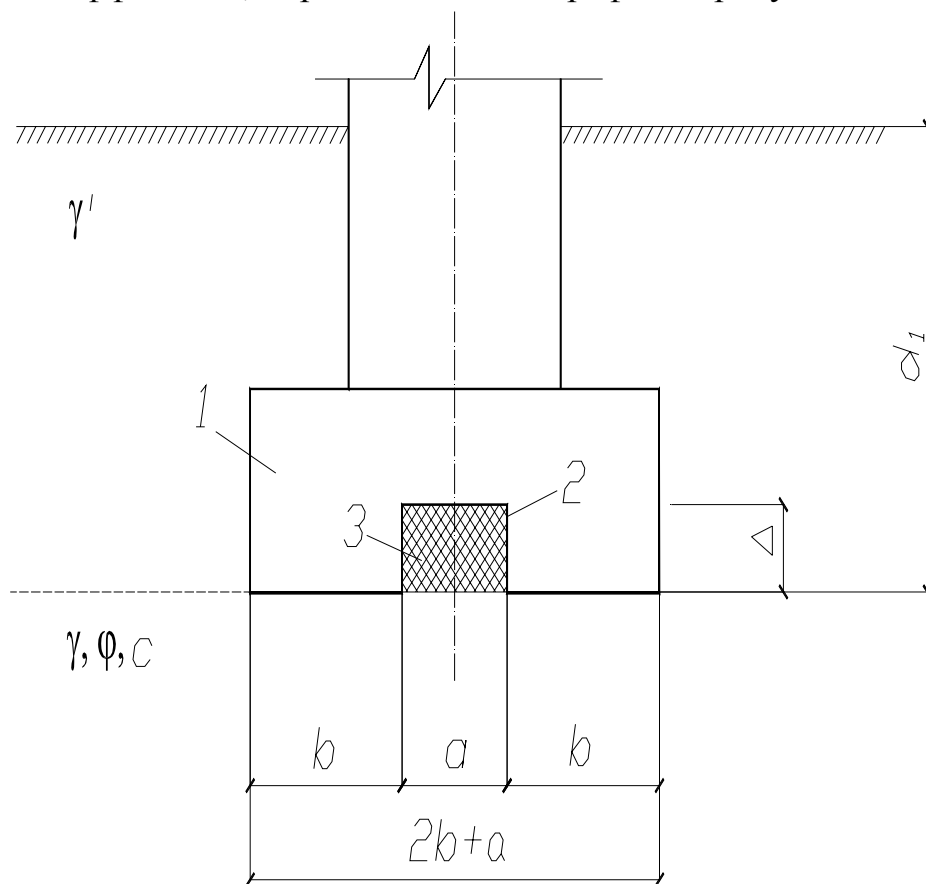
Фундамент с продольным вырезом по подошве
